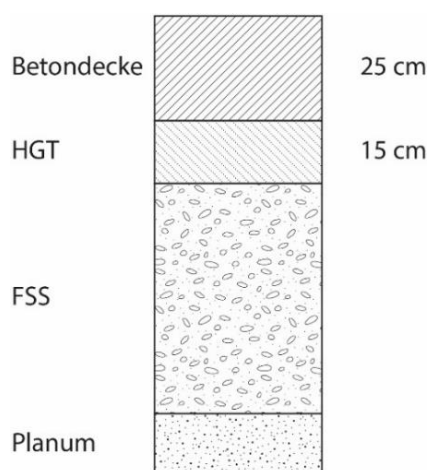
Lkw-Stellflächen einer T+R-Anlage > 30 Jahre Liegedauer mit Betondecke auf HGT auf FSS
